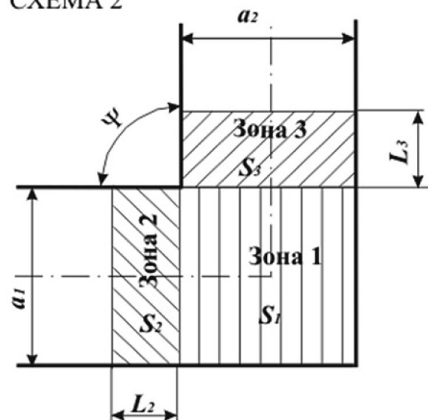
Расчетные схемы к определению площади обнажения кровли в различных зонах сопряжения выработок примыкающих друг к другу под тупым и прямыми углами
